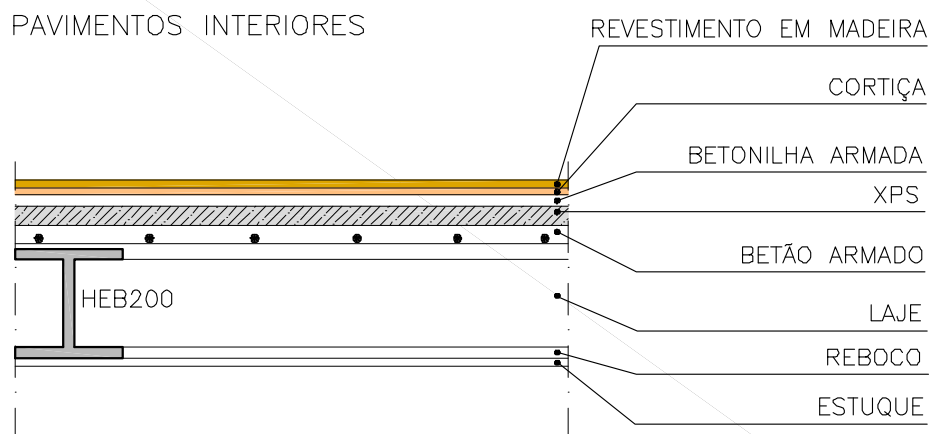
Tipo de pavimento utilizado na reabilitação.
